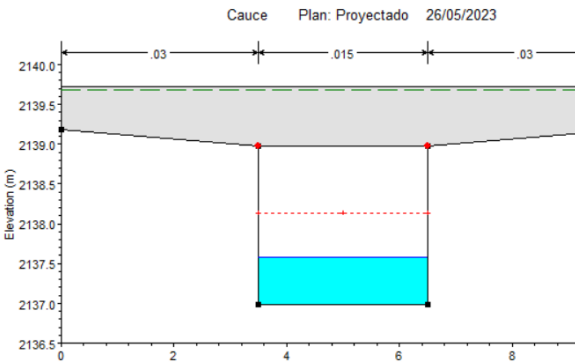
Sección 72, Box Culvert 1- (Aguas abajo)- Abscisa 0+69.74
